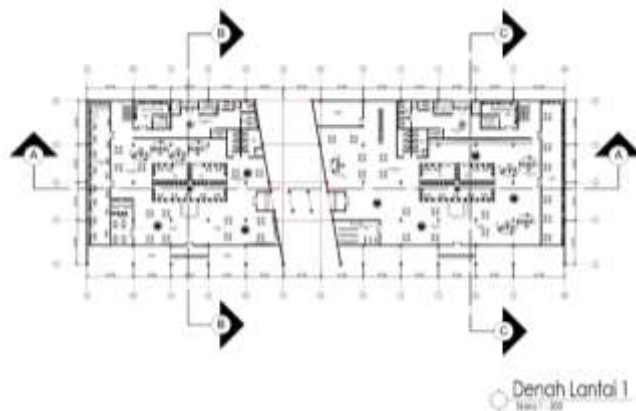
Layout Plan *Café Library* Di Kota Bima
